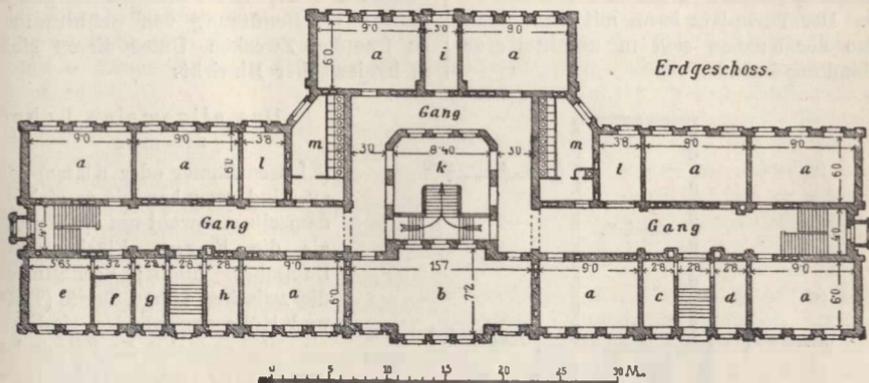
Grundriß des Volksschulhauses in Dresden (s. S. 652).
